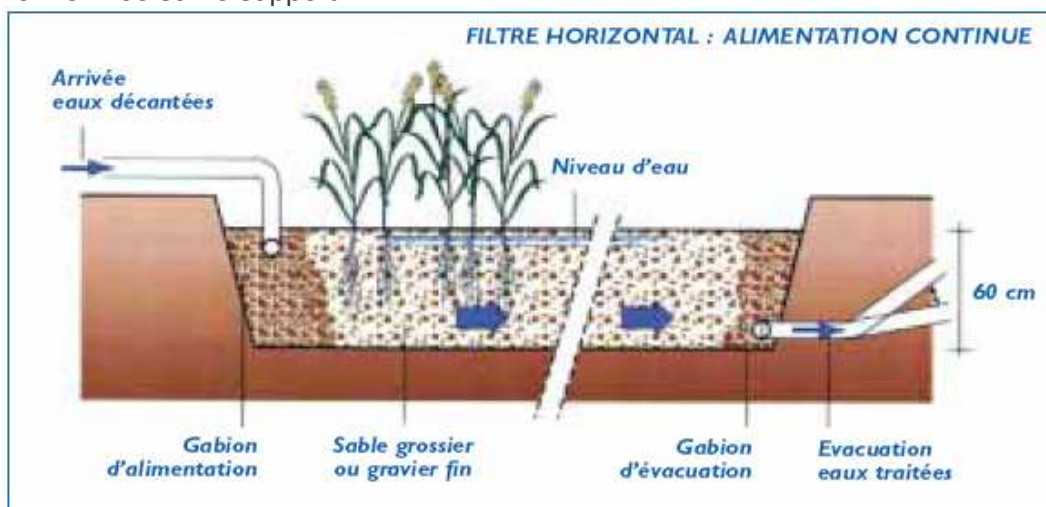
Coupe transversale d'un filtre planté de roseaux à écoulement horizontal
